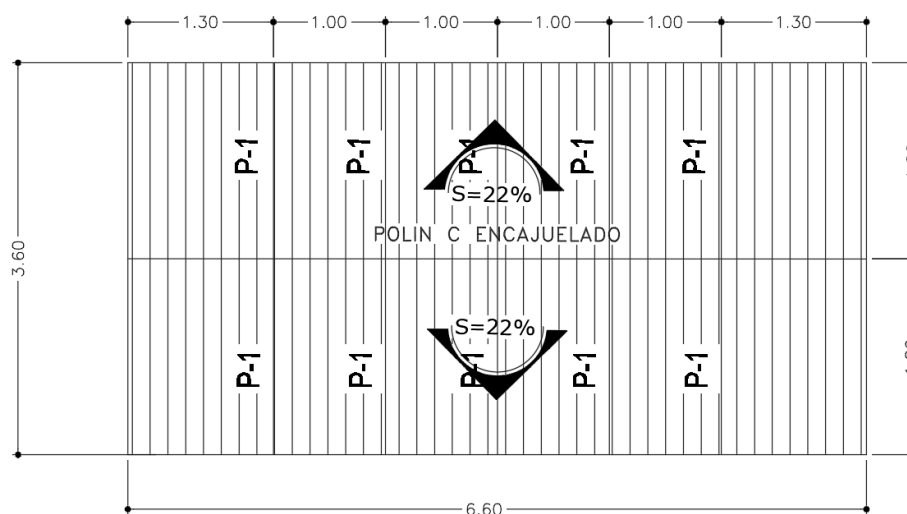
Esquema de techo aplicado a la vivienda
